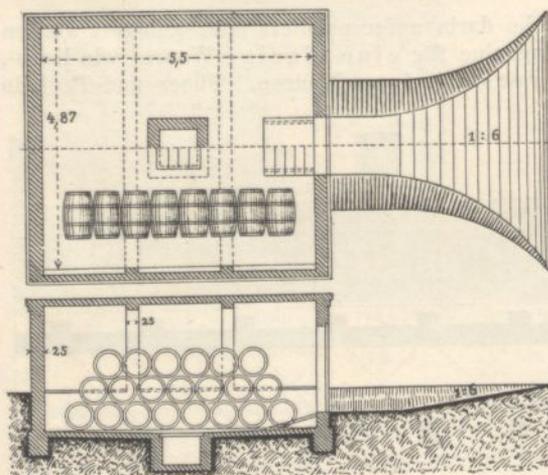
und 639. Grundriss und Längenschnitt.
